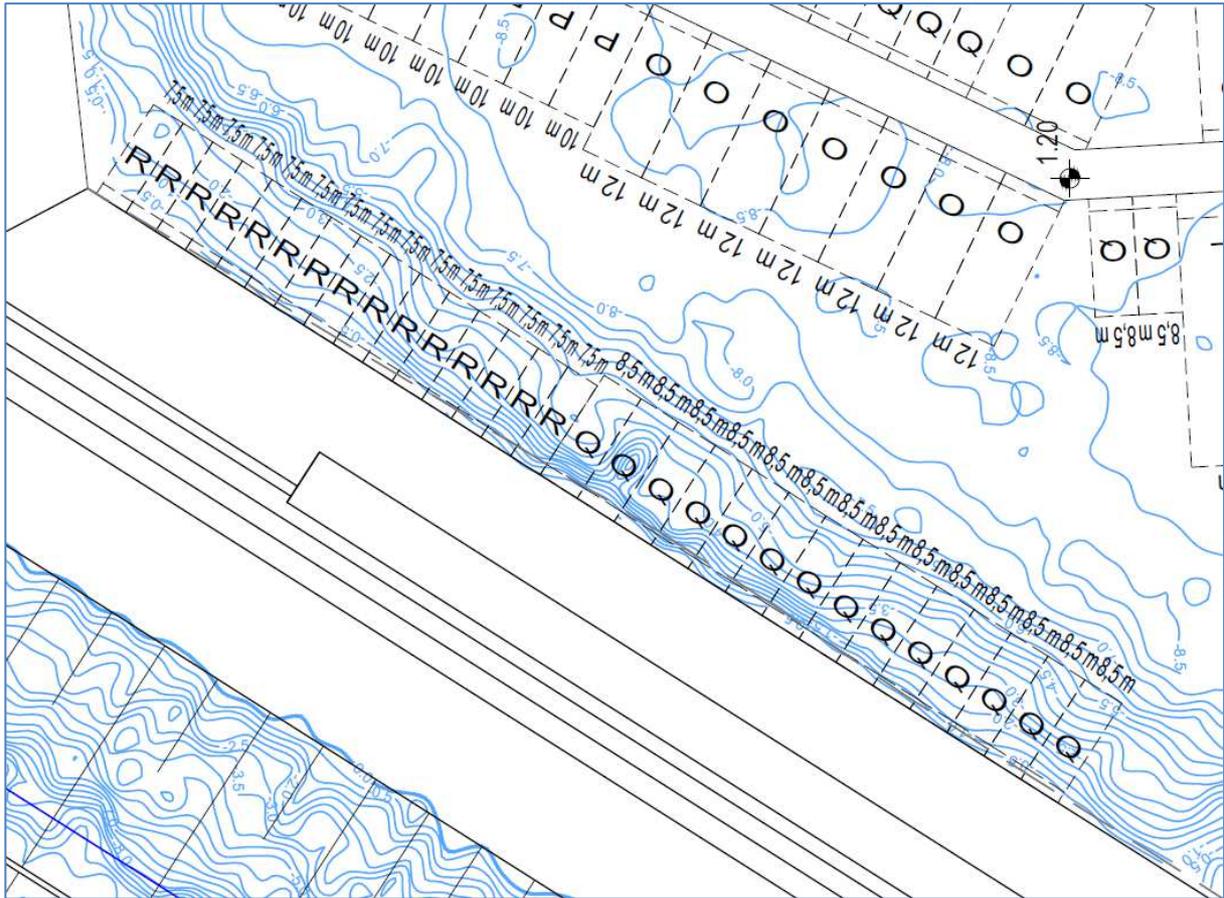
Stralcio disegno V3-D04-01: layout Molo Sud – dettaglio secondo braccio
